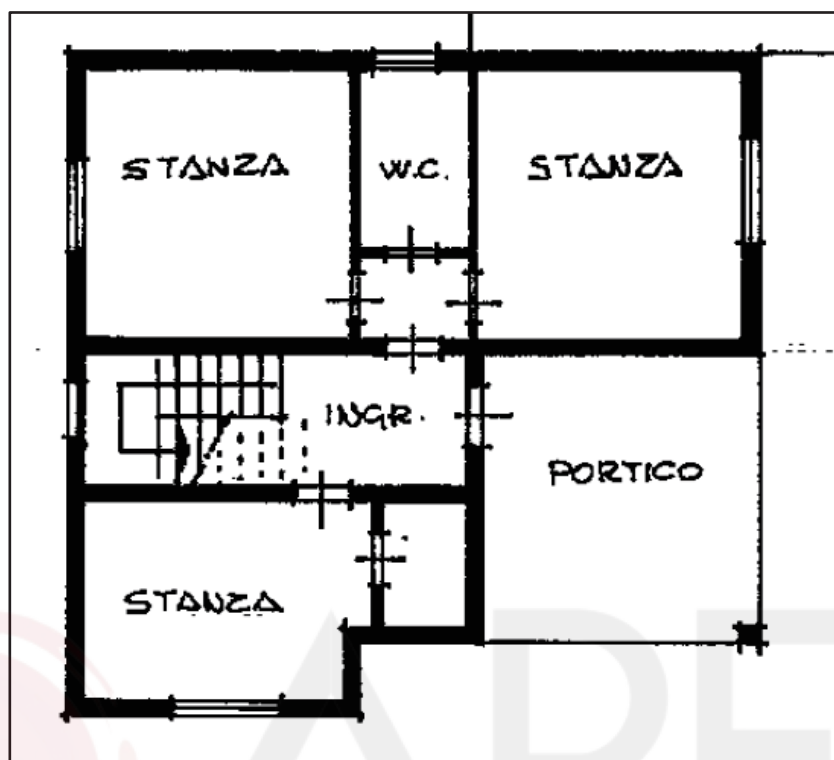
Pianta piano terra (tratta dalla planimetria catastale)
